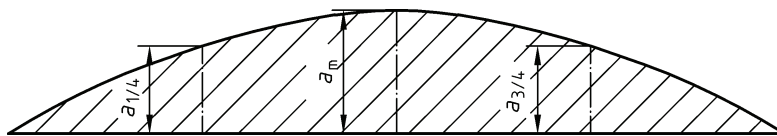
b) — Schrägrippe — Längsschnitt in Rippenmitte
